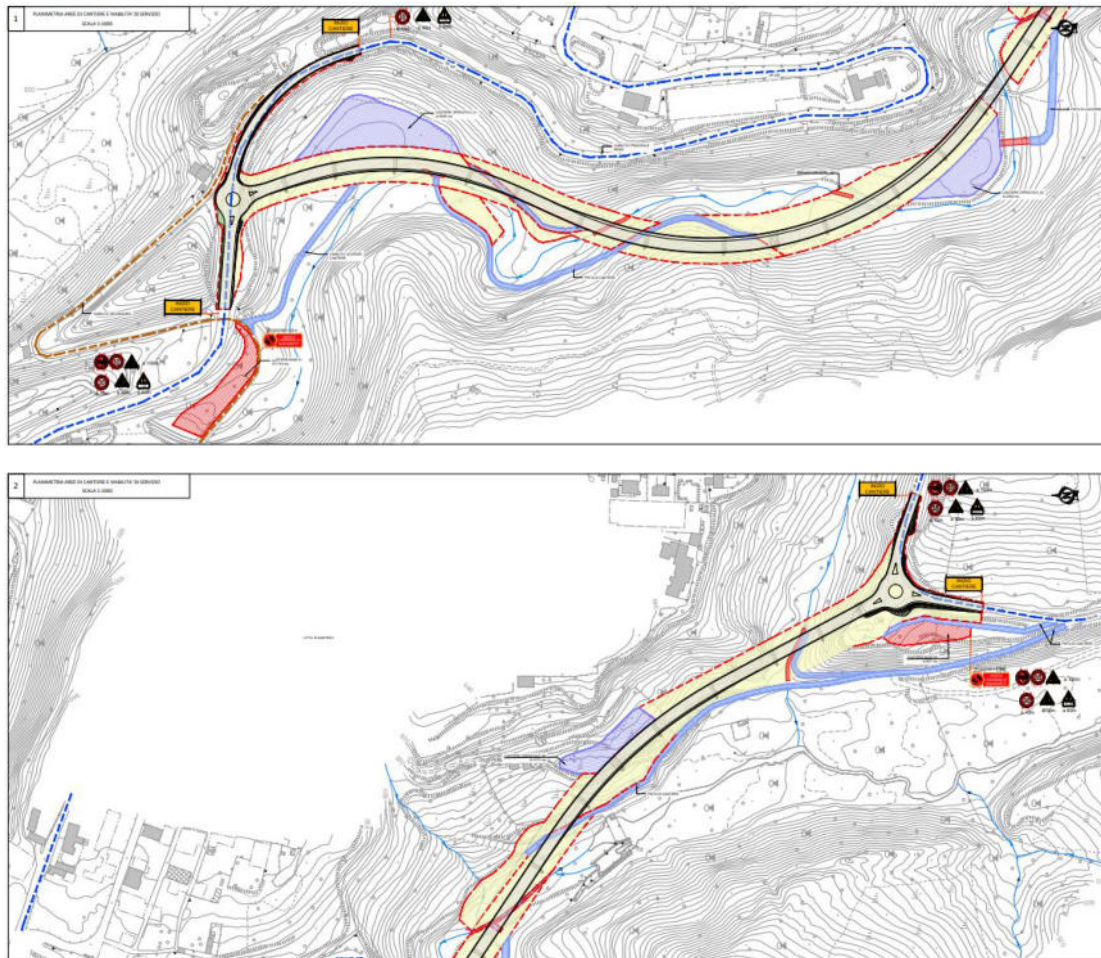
Planimetrie aree di cantiere e viabilità di servizio
